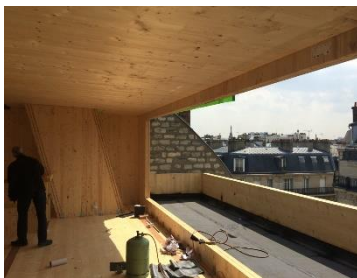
Aperçu de la structure bois et des niveaux R+6 et R+7 - toiture terrasse
